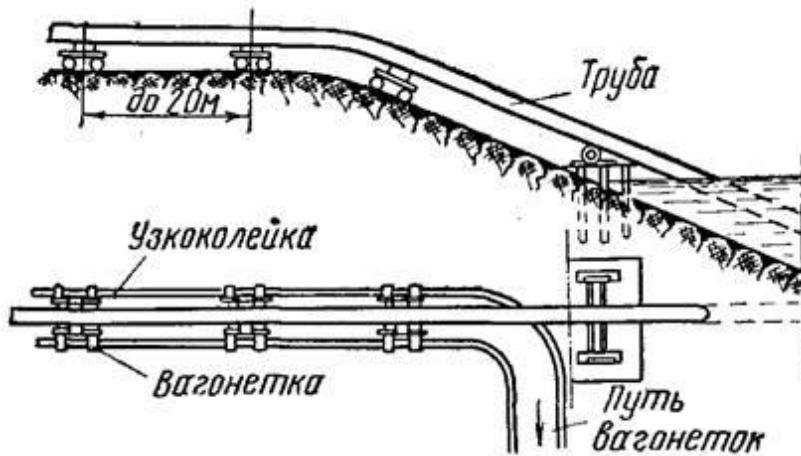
Схемы укладки трубопроводов на склонах оврагов и балок при строительстве дюкеров
